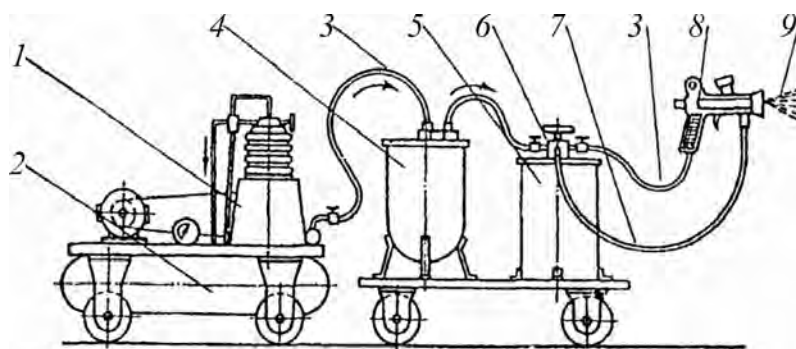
Схема компрессорного огрунтовочного агрегата: 1 — компрессор; 2 — воздухосборник; 3 — воздушный шланг; 4 — масловодоотделитель; 5 — красконагнетательный бачок; 6 — редукционный вентиль; 7 — огрунтовочный шланг; 8 — краскораспылитель; 9 — факел
